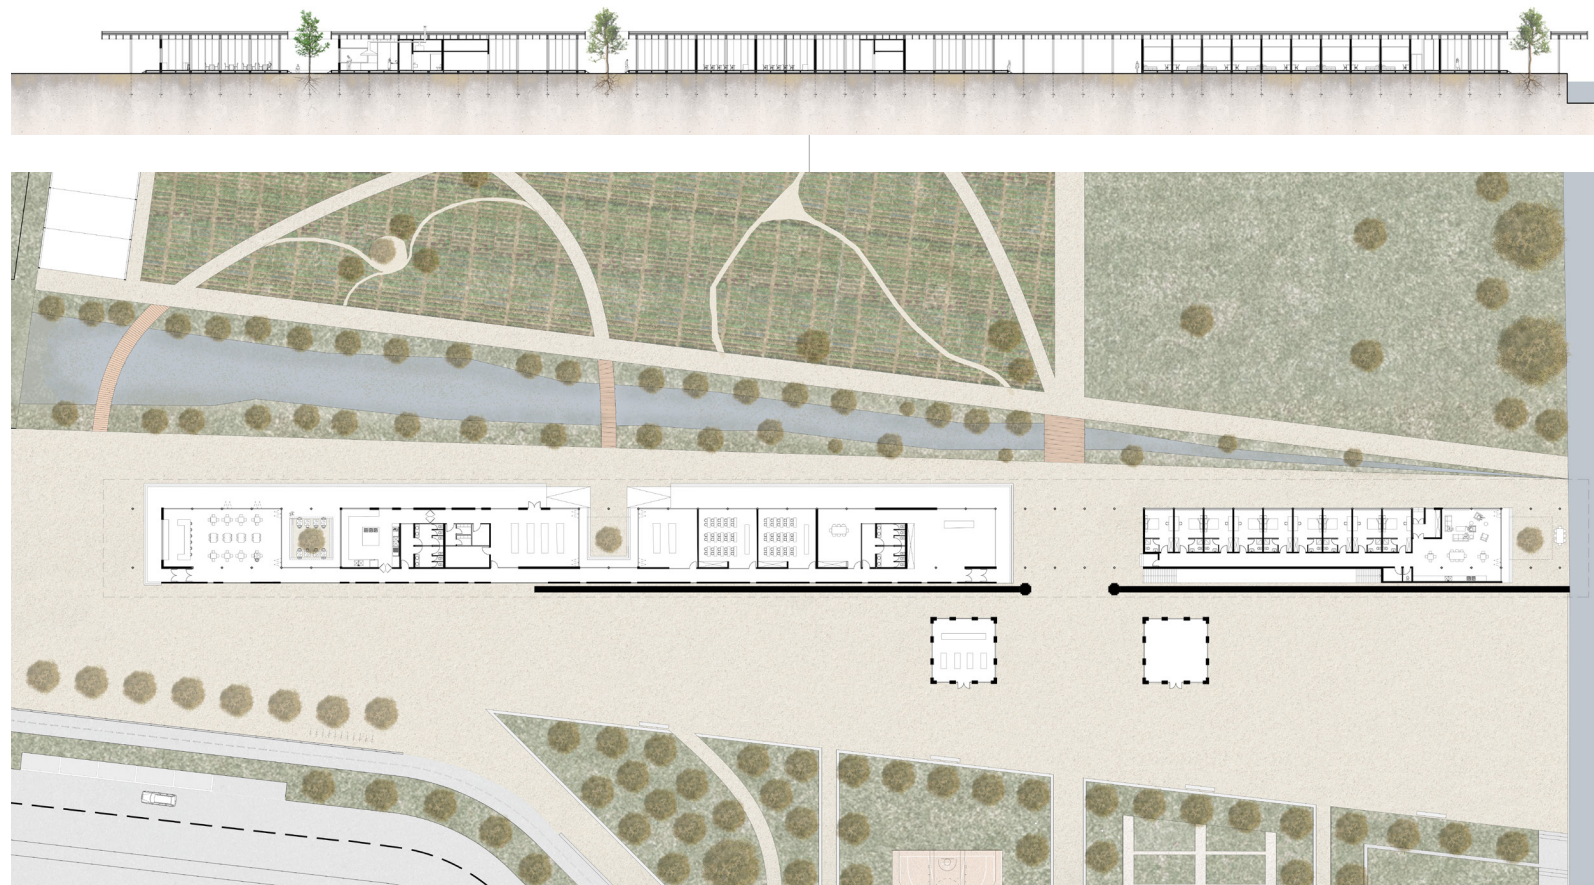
et 59 Plan à l'échelle du bâtiment et coupe longitudinale..
